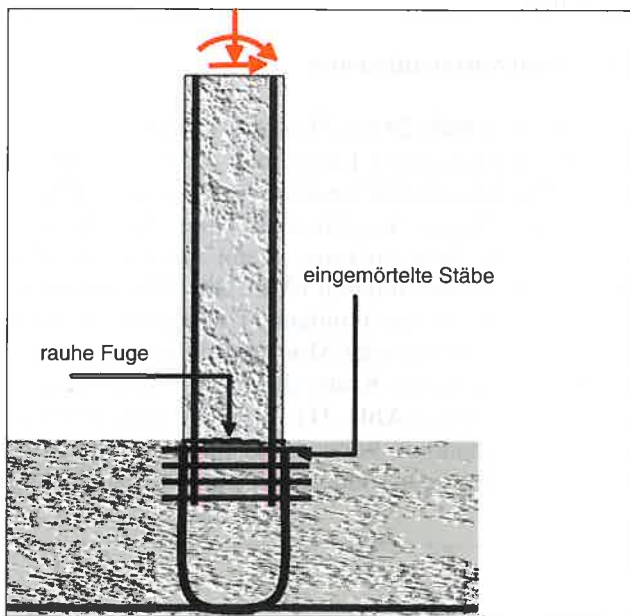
Anschluss einer Stahlbetonstütze an ein Fundament mit Anschlussbewehrung. Bewehrungsanschluss zulässig
